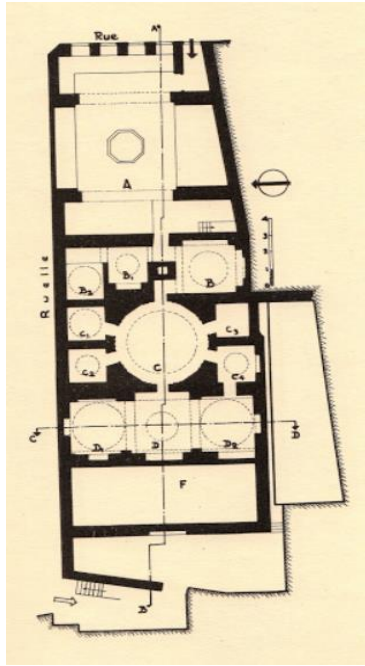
مسقط أفقي للوضع الراهن لحمام الباشا بمدينة
